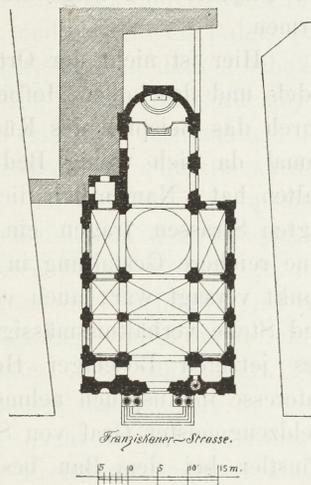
Bonn. Grundriss der St. Michaelskirche.
